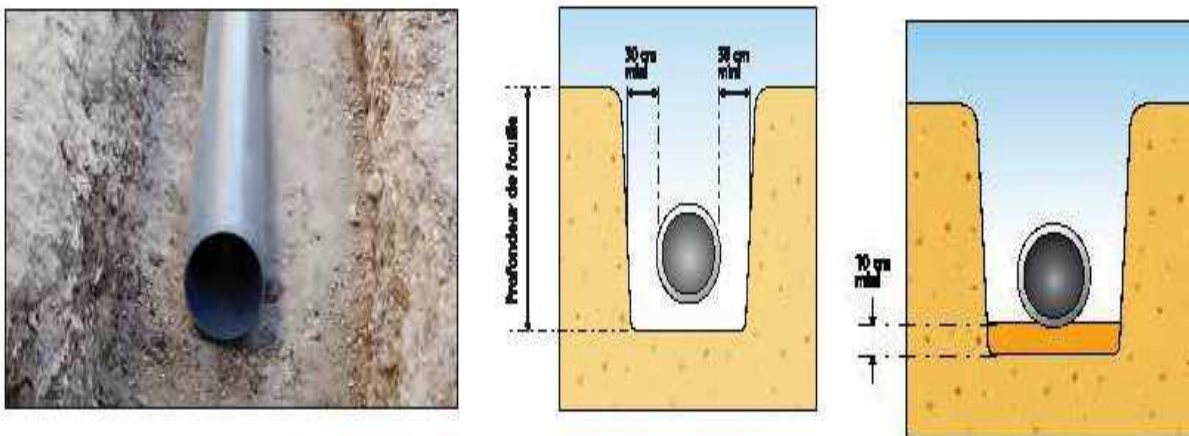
Coupe transversale d'une tranchée avec la mise en place de la conduite (internet)
